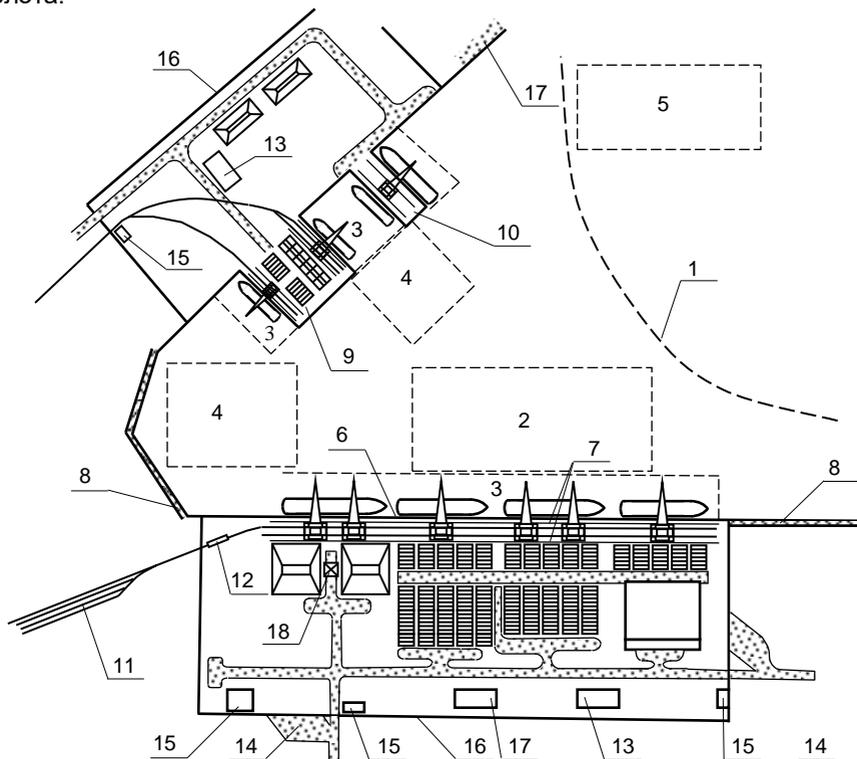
Схема расположения устройств в речном порту ковшового типа:
